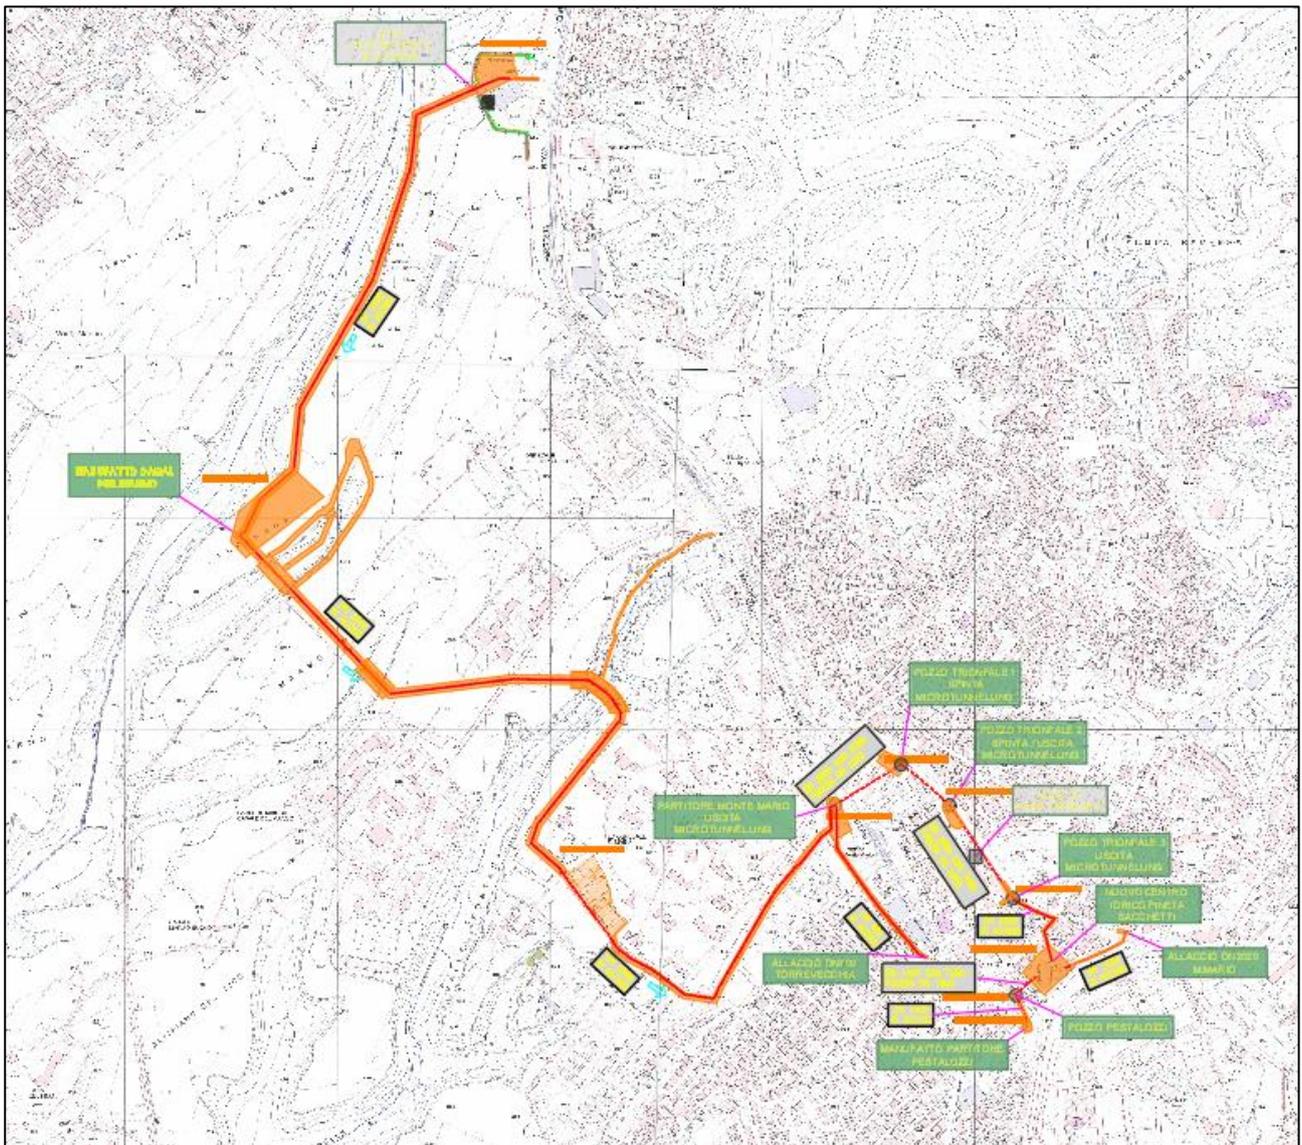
Planimetria degli interventi di progetto con indicate le aree di cantiere e i principali manufatti e pozzi.
